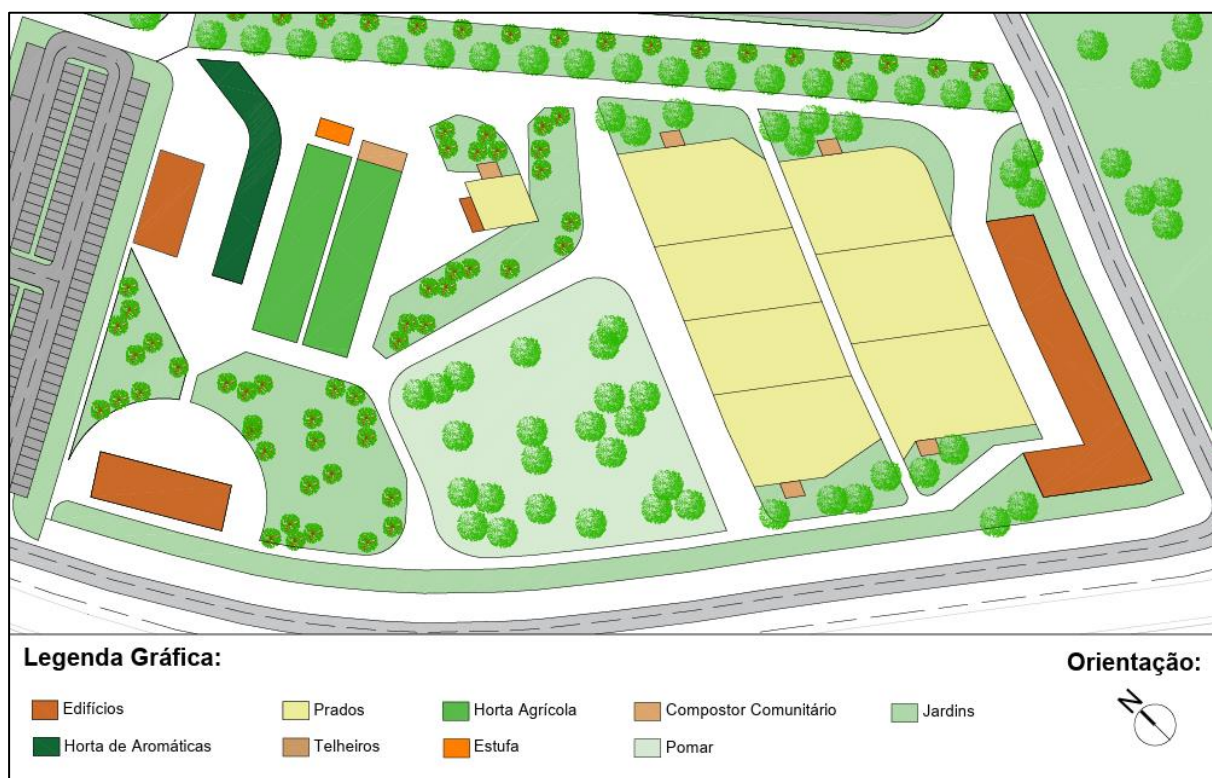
Planta de Pormenor da Quinta Pedagógica.
